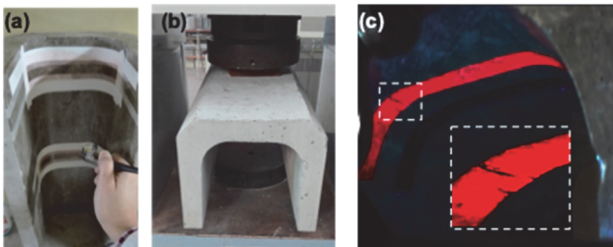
模型でのひび割れ可視化試験(a)塗装中(b)载荷試験(c)ブラックライト照射中下のひび割れ観察
